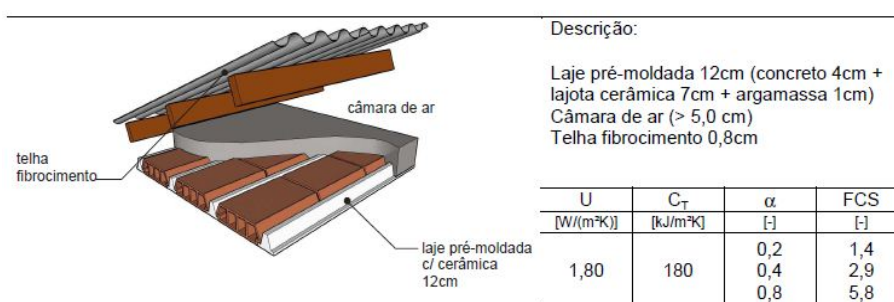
Telhado de fibrocimento com laje pré-moldada feita de concreto, lajota cerâmica e argamassa(LabEEE 2010)
